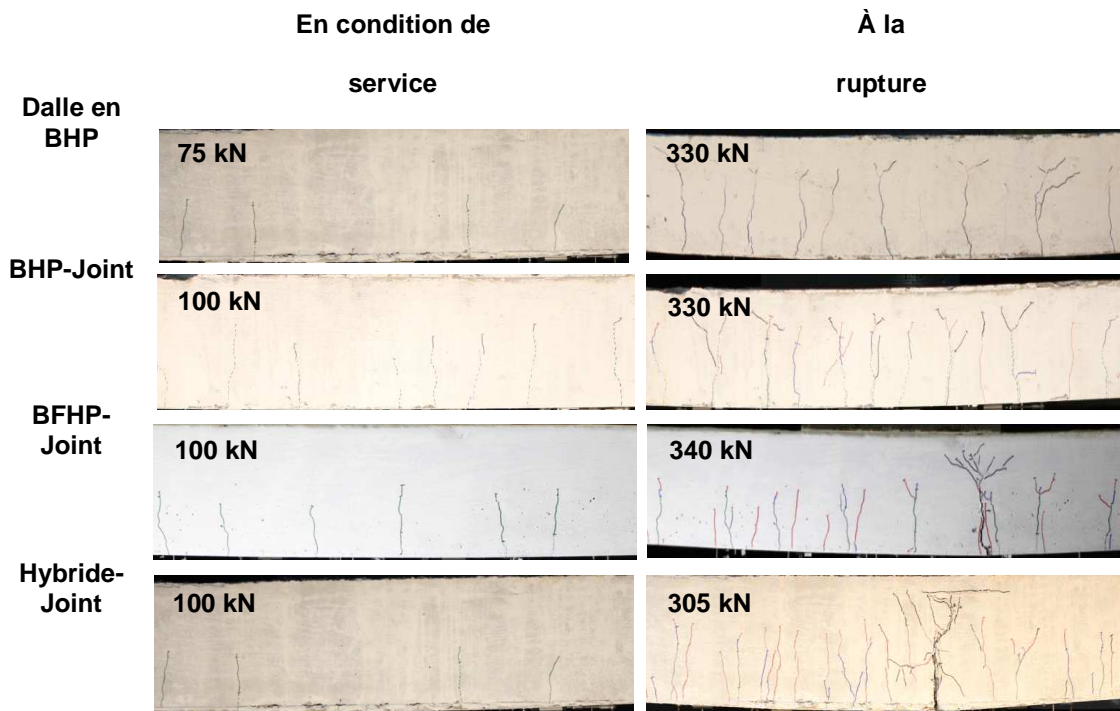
Schéma de fissuration en condition de service et à la rupture
